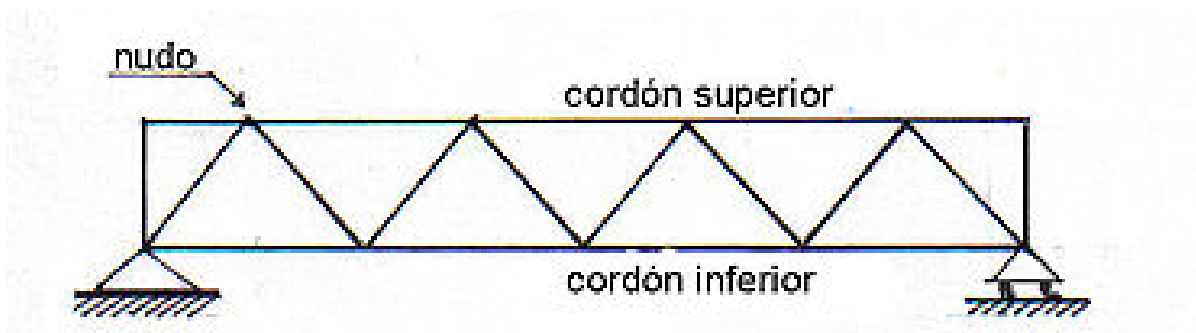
Cercha metálica tipo Warren. Fuente: [http://www.construmaticacom/construpedia/images/thumb/9/93/Viga\\_Warren.jpg/370px-Viga\\_Warren.jpg/](http://www.construmaticacom/construpedia/images/thumb/9/93/Viga_Warren.jpg/370px-Viga_Warren.jpg/) (2017)
